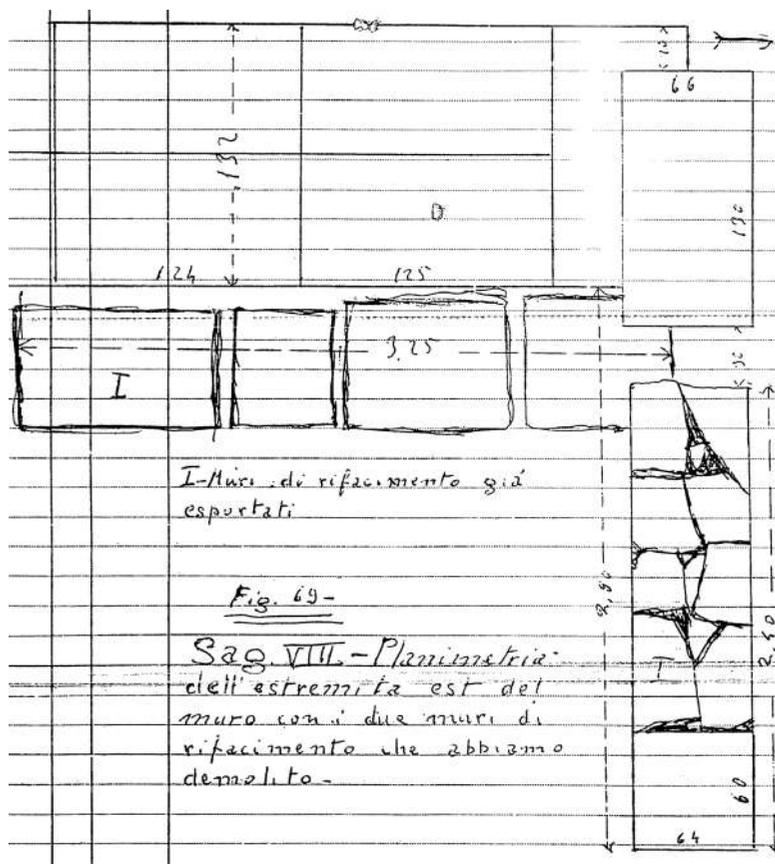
Sag. VIII - Planimetria dell'estremità est del muro con i due muri di rifacimento che abbiamo demolito -
